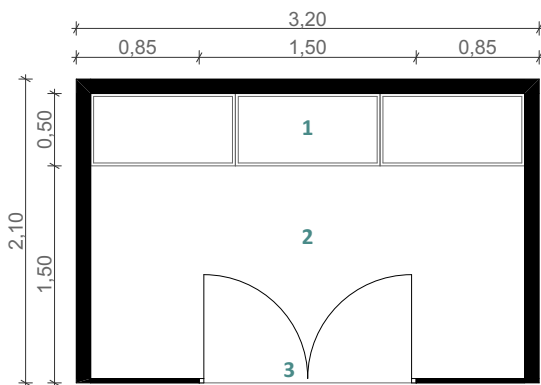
Planta área de ropa, zapatos, animales, hogar y artesanías. Fuente: Autores.
